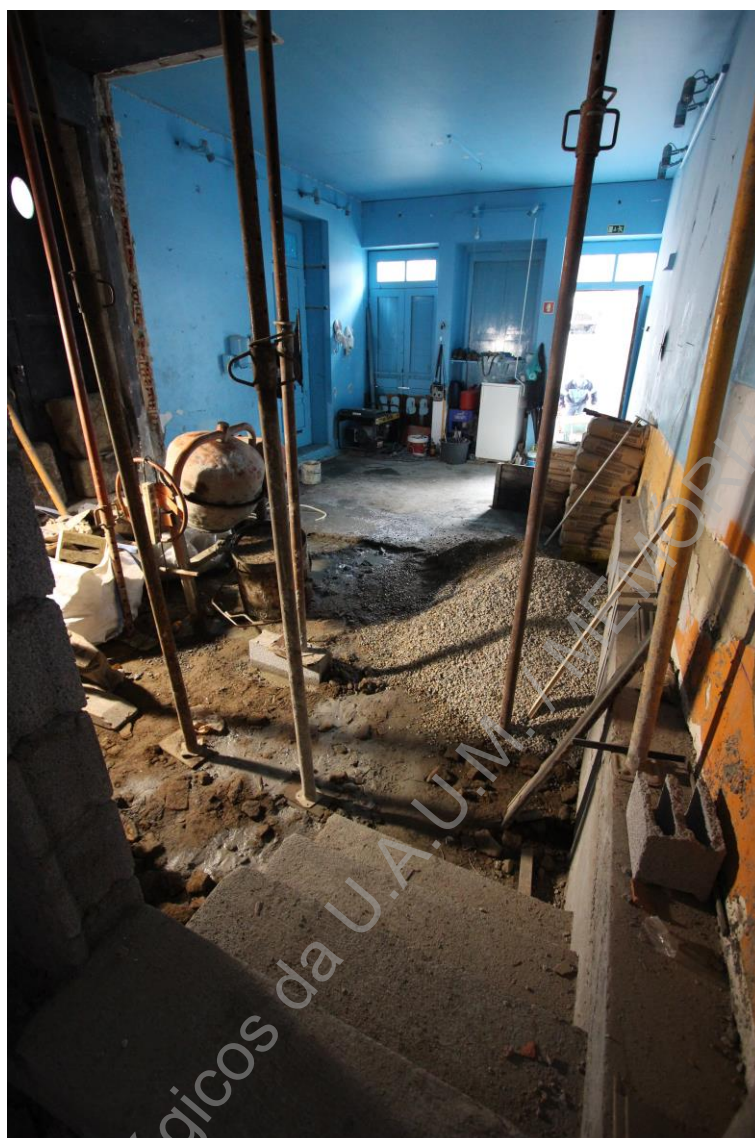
Acompanhamento do ensoleiramento da sondagem com cimento e cascalho.
